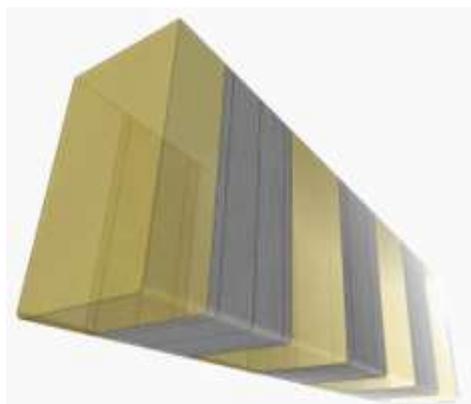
Refuerzo de fibra de carbono en vigas.
